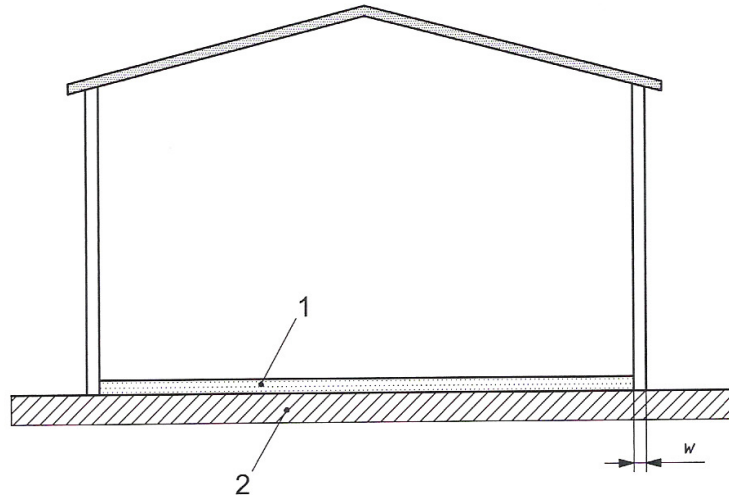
Rappresentazione grafica di un pavimento appoggiato su terreno, dove 1 indica il pavimento a contatto con il terreno e 2 il terreno.
